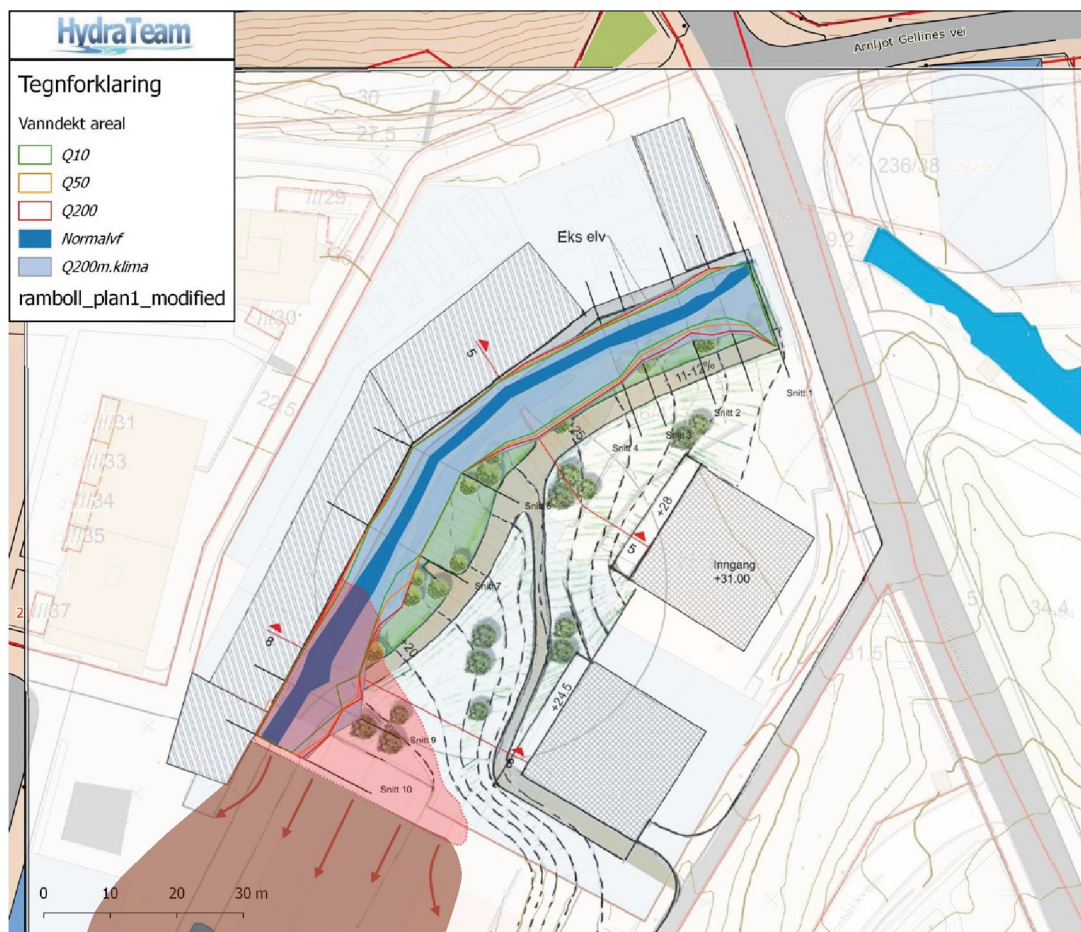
Vannlinjeberegninger viser at dersom kulvert nedstrøms går full, vil det kun påvirke nedre del av planområdet da Alna har bra fall gjennom hele planområdet. Tegnet av HydraTeam AS.
